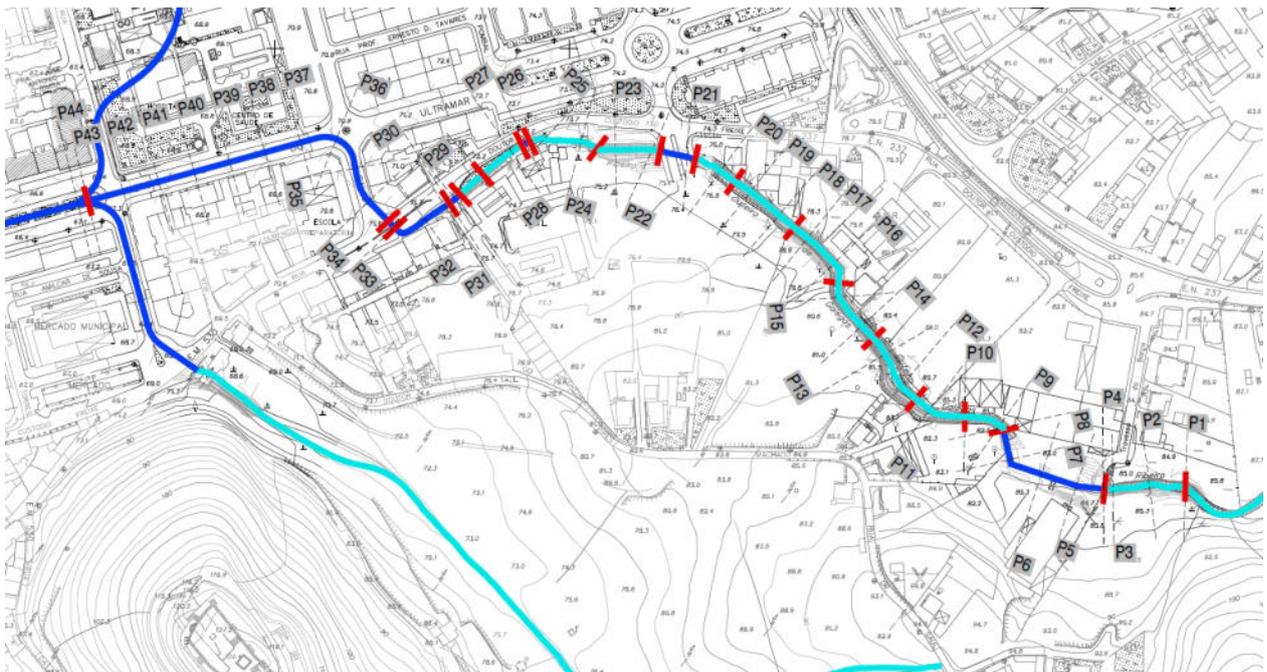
Ribeira do Outeiro das Galegas – Secções de escoamento. (Fonte: Projeto de Execução, 2023)
